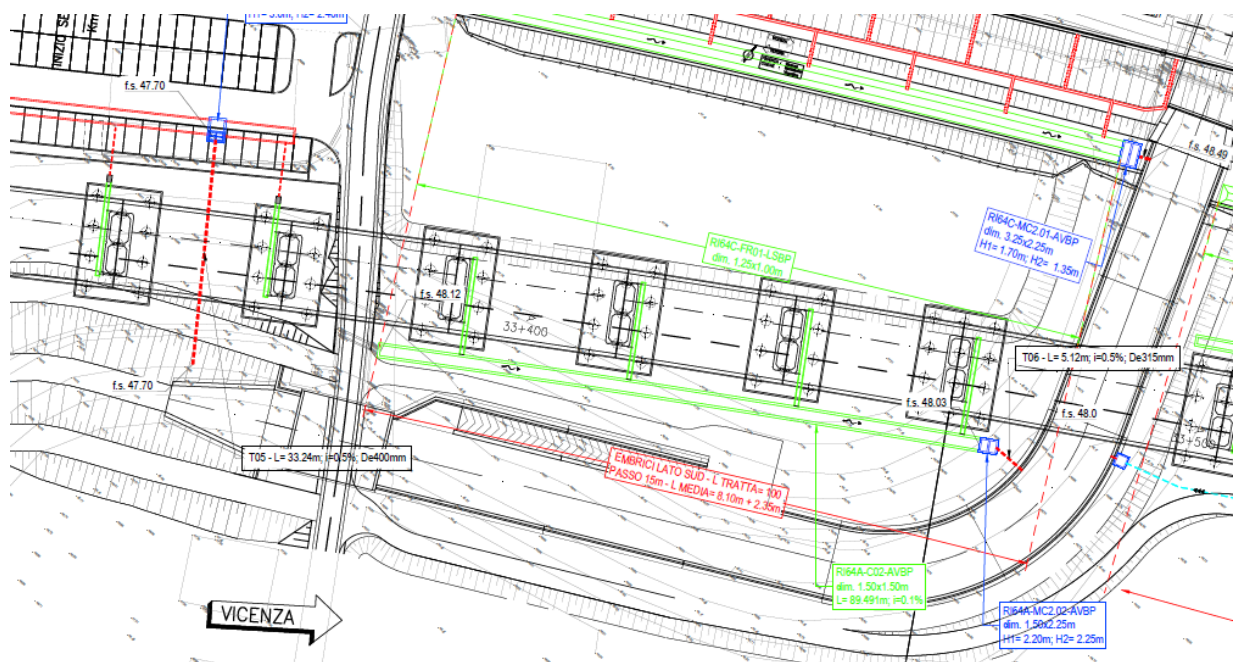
Stralcio planimetrico del fosso rettangolare a servizio del viadotto tra le pile 8 e 11
